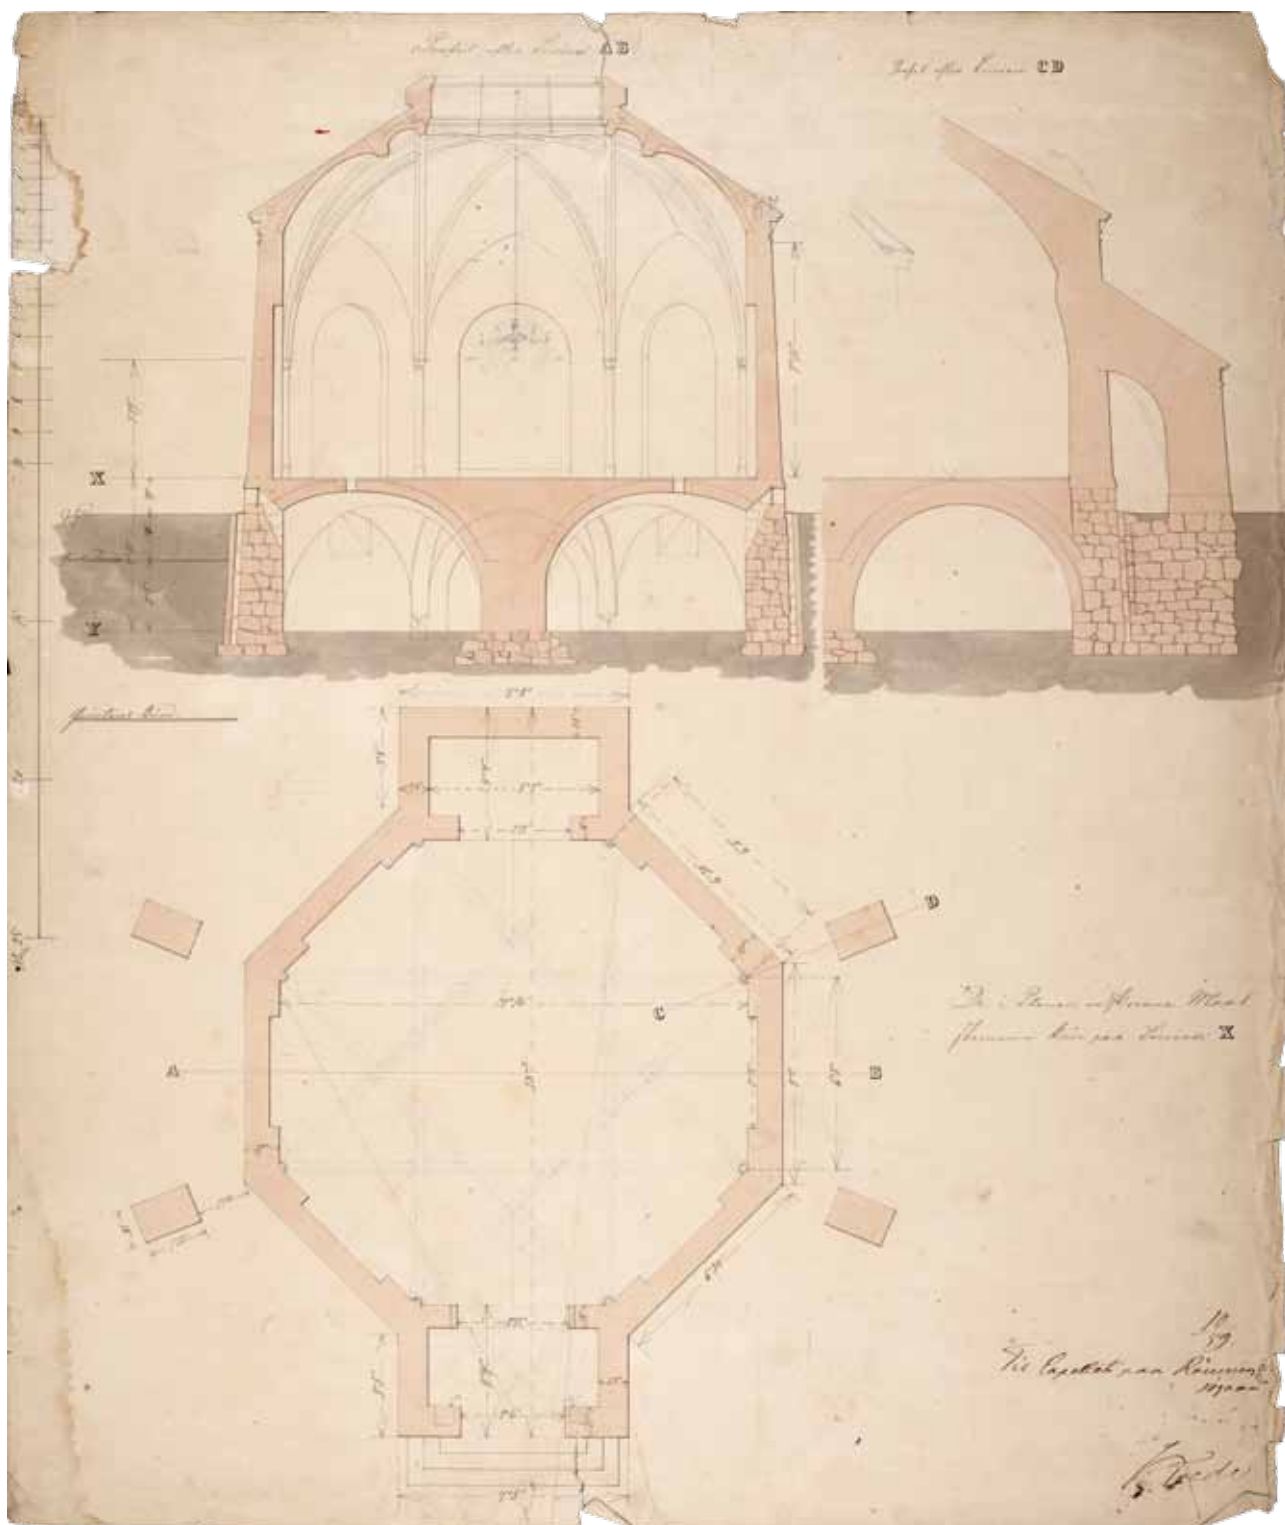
Plan af hovedetagen, tværsnit set mod nordøst samt snit af sprængbue. 1:150. Tegninger ved V. Tvede, 1859. I Danmarks Kunstbibliotek. – Plan of main floor, cross section looking north east and section of a flying buttress.
